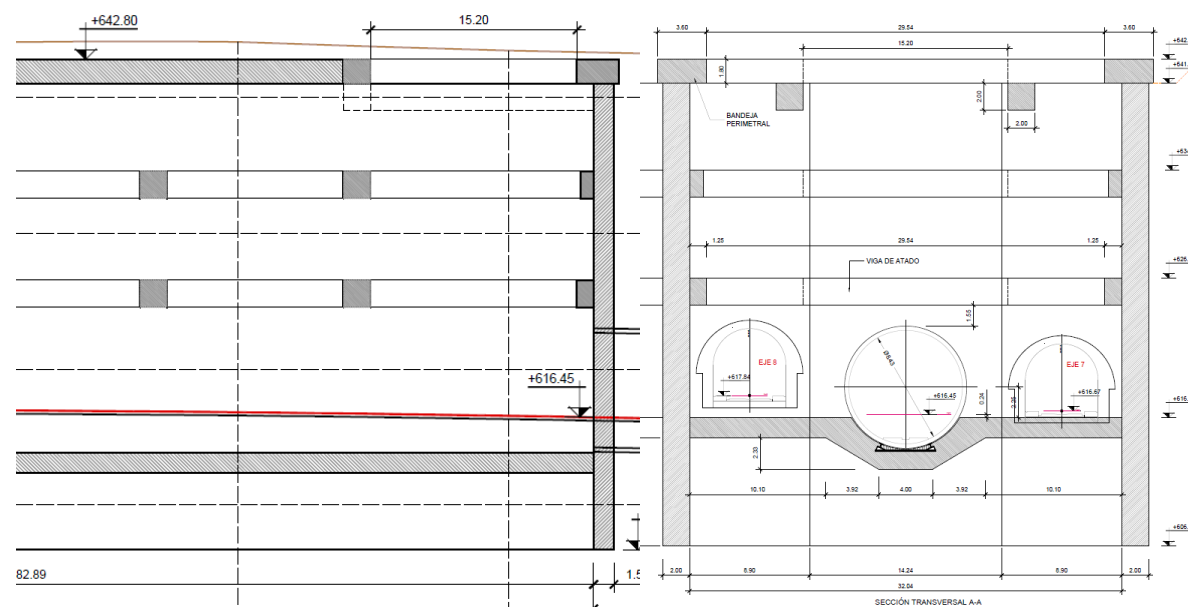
Sección transversal y longitudinal Telescopio 1 y PET-2 (Alt. 2-4)
